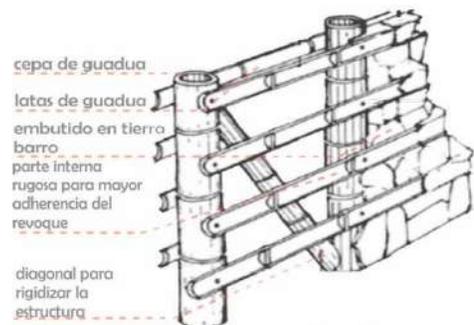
Detalle constructivo Bambú-Guadua
